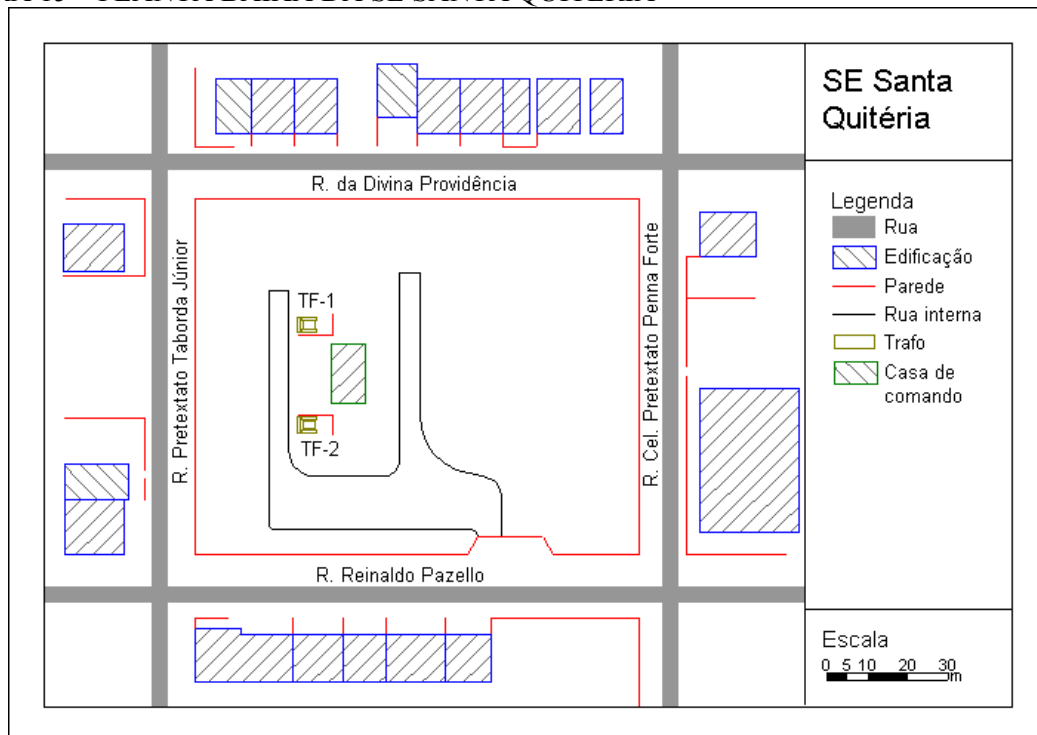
PLANTA BAIXA DA SE SANTA QUITÉRIA
